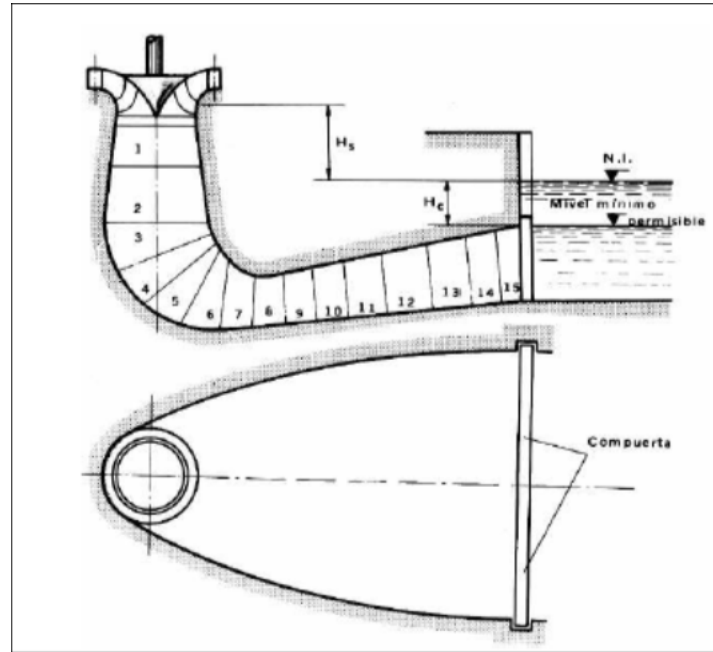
Vista alzado y planta Tubo aspiración acodado
